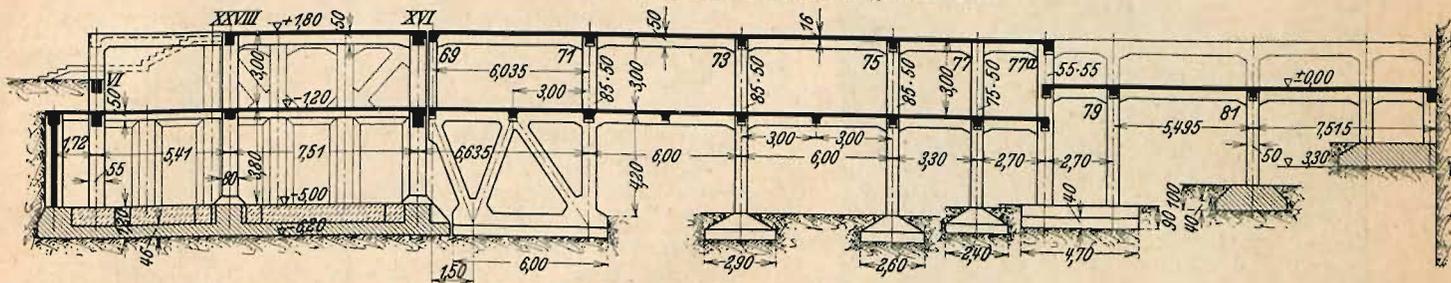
Eisenbetonfundamente. Längsschnitt.
